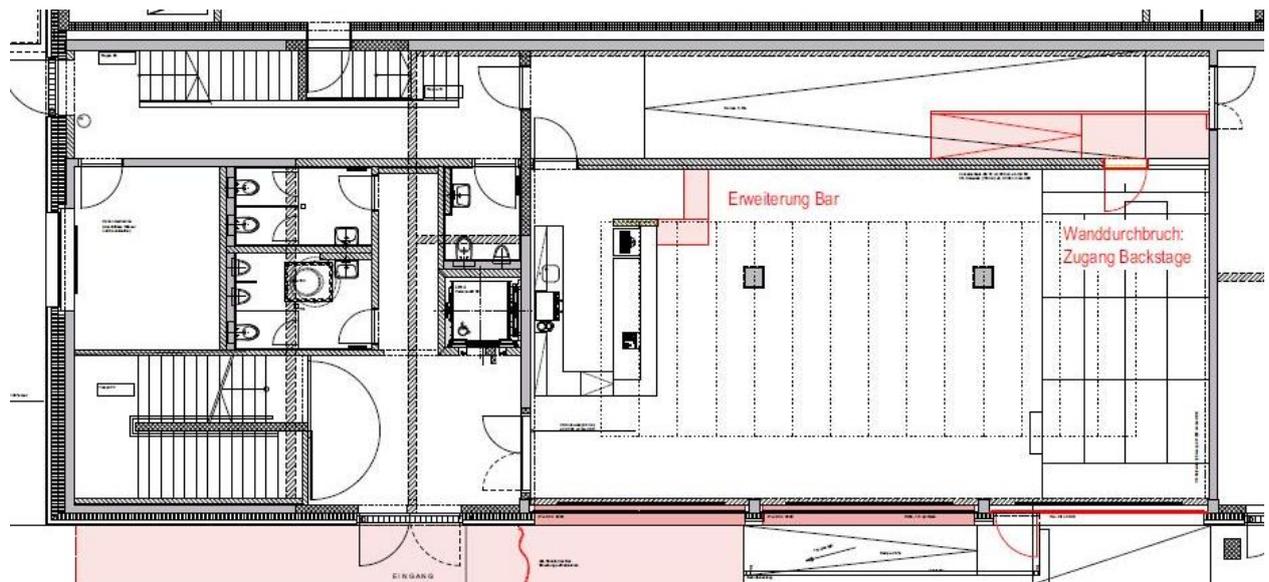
Club: Barerweiterung und neuer Bühnen-/Backstagezugang mit Rampe
